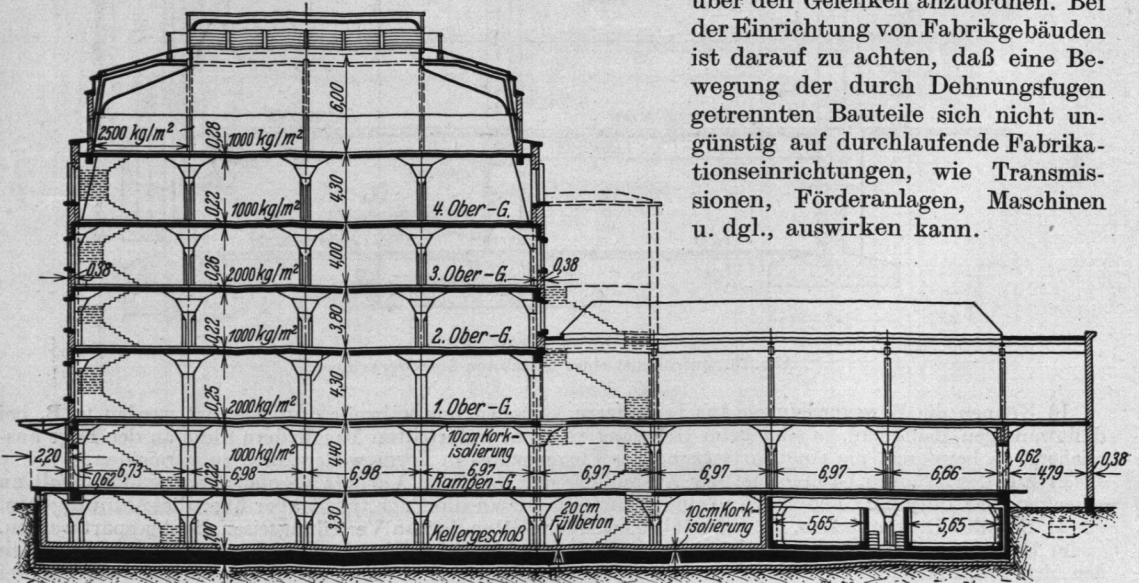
Lager- und Versandgebäude in Eisenbeton mit Pilldecken für eine Brauerei.
